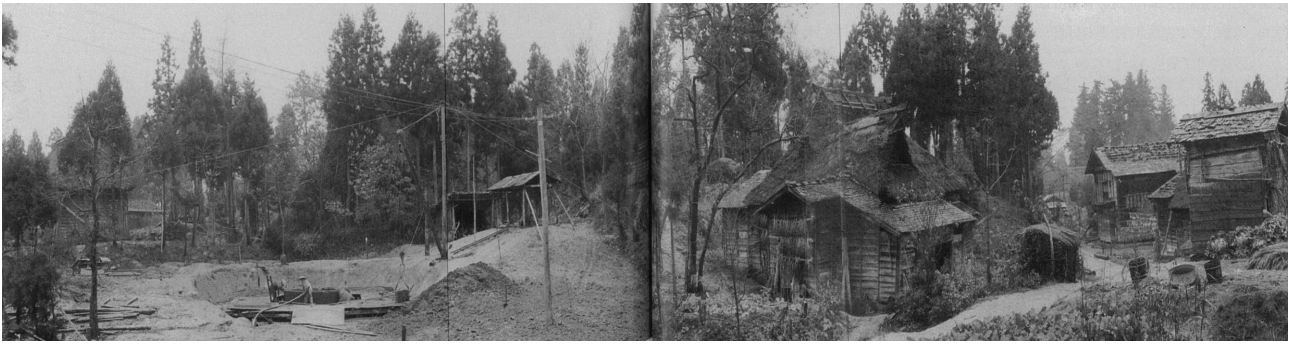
柄ヶ原地すべり地の第1号集水井の施工状況
